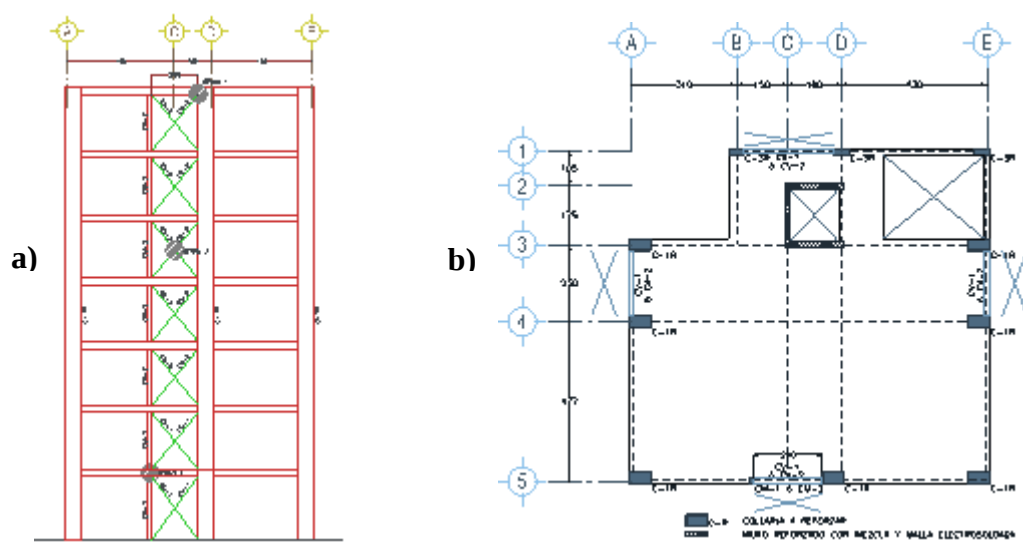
a) Alzado y b) Planta tipo, del Edificio Ámsterdam tomado de los planos estructurales proporcionado por Romo Heredia (2020).
